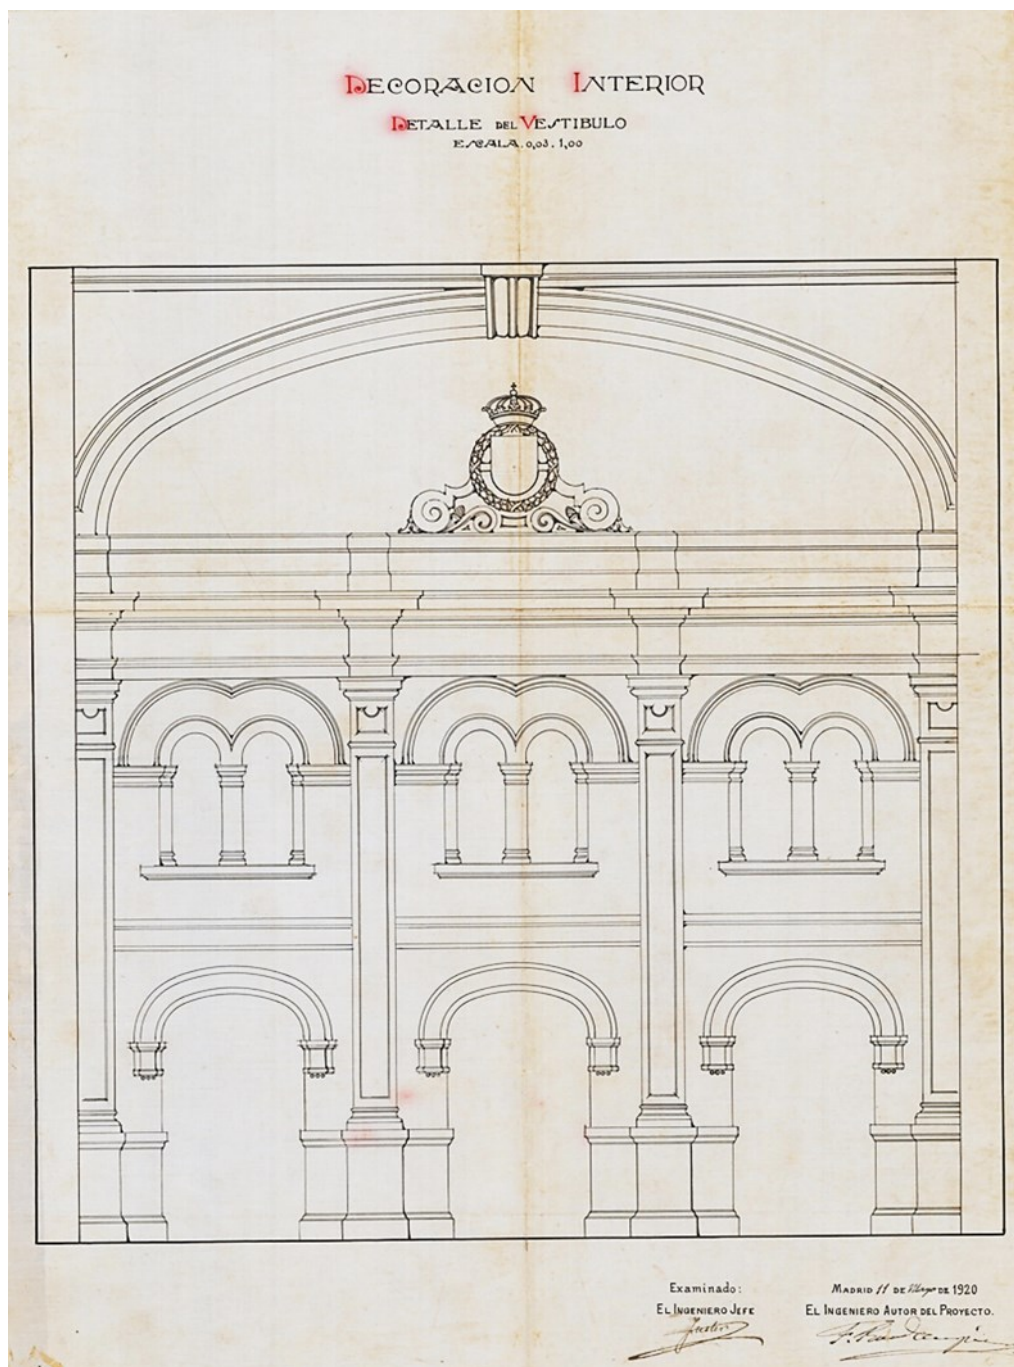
Alzado original de la decoración parietal de la zona sur del vestíbulo diseñada por Ramírez de Dampierre en 1920. AGA, Caja 25/08126.
